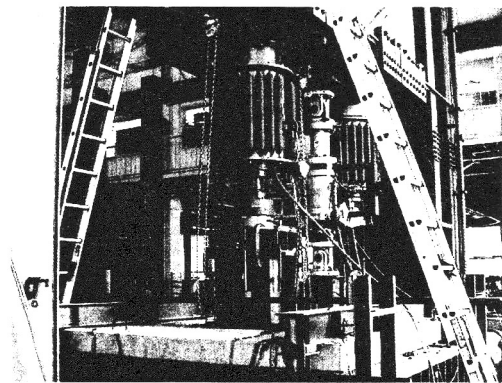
5 000 kN ジャッキによる破壊性状確認試験の状況
